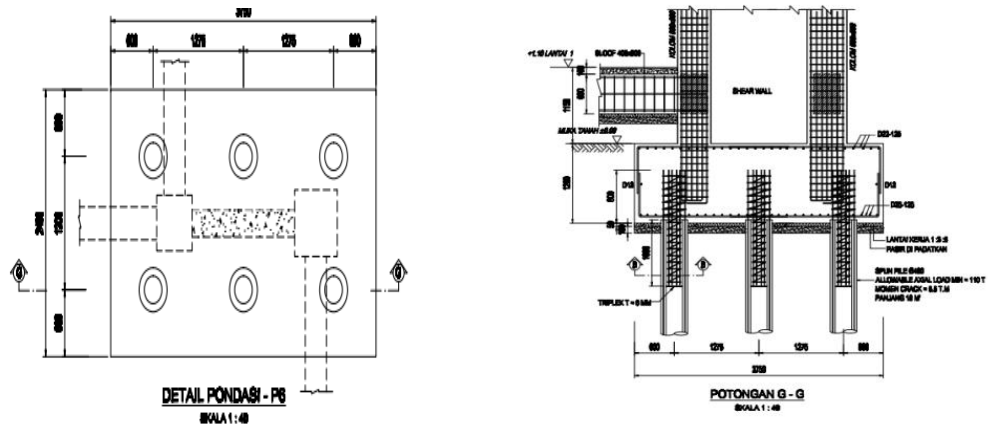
(a) Pondasi 2 Tampak Atas (b) Pondasi 2 Tampak Samping
